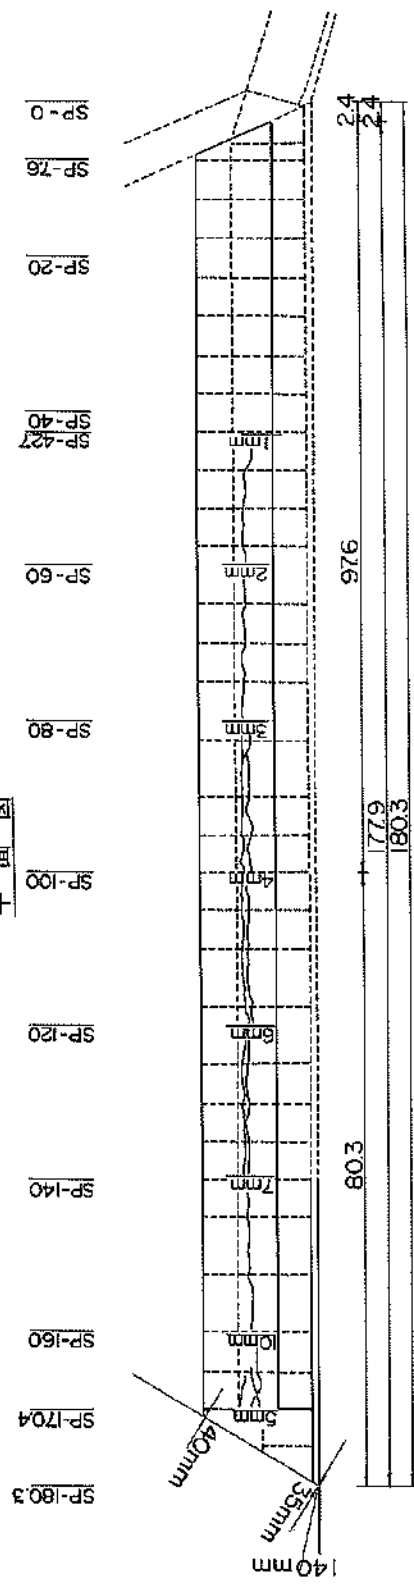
エプロンクラック平面図 (入舟地区, ④岸壁(-6.0m))
